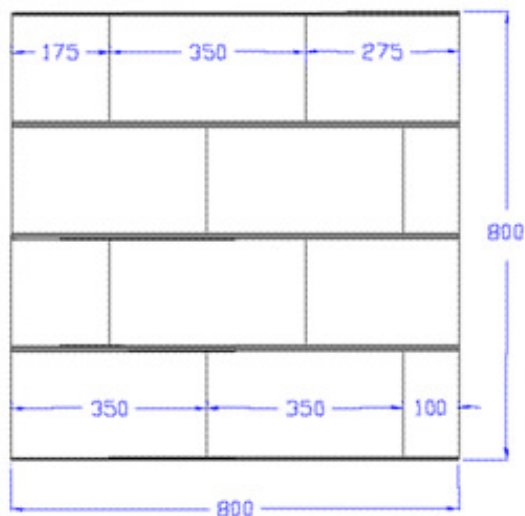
Dimensões e aparelho de assentamento do provete ensaiado
